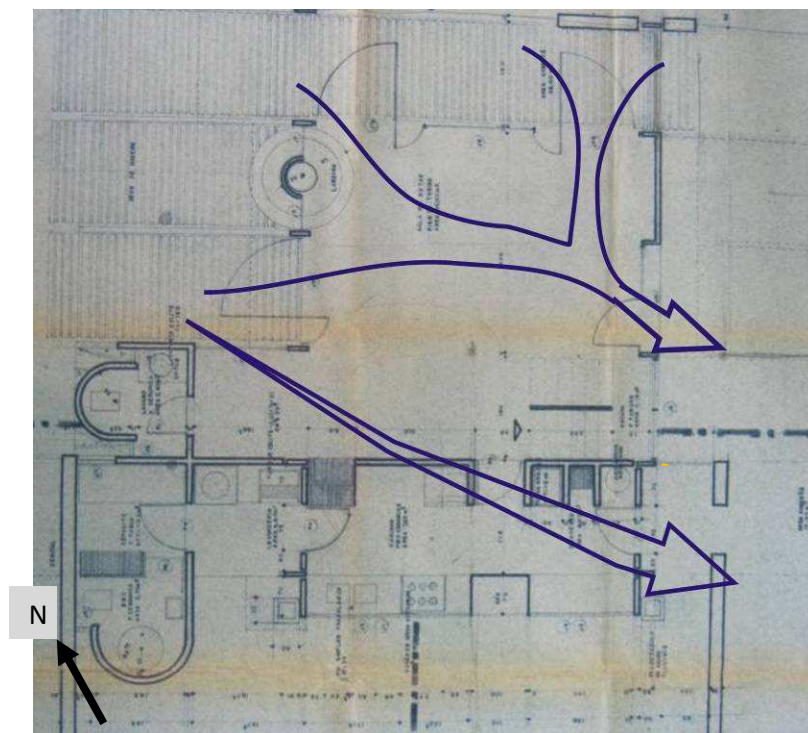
Planta do pavimento térreo: Circulação interna de ar.
